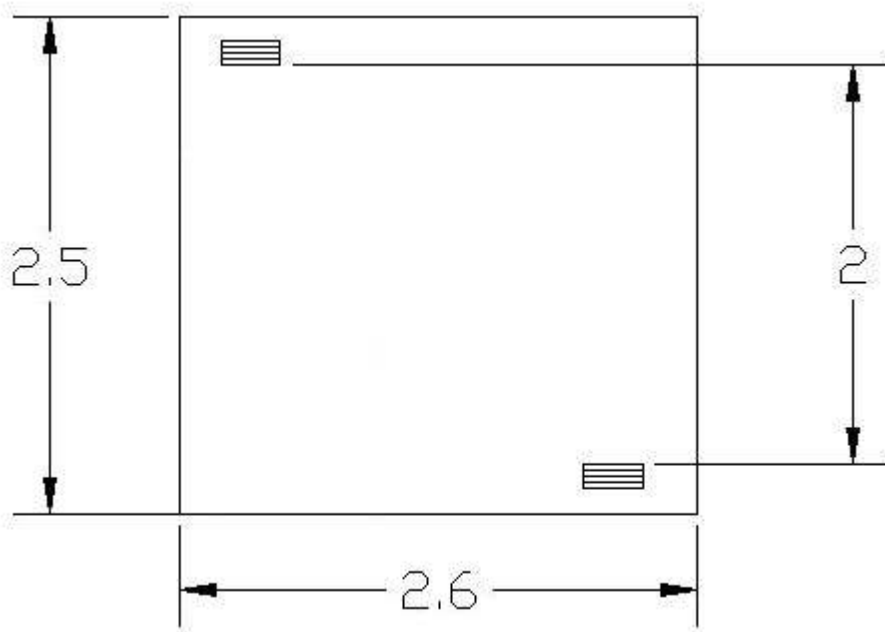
Situación de las rejillas para los trasteros con rejillas mixtas (dimensiones en metros)
